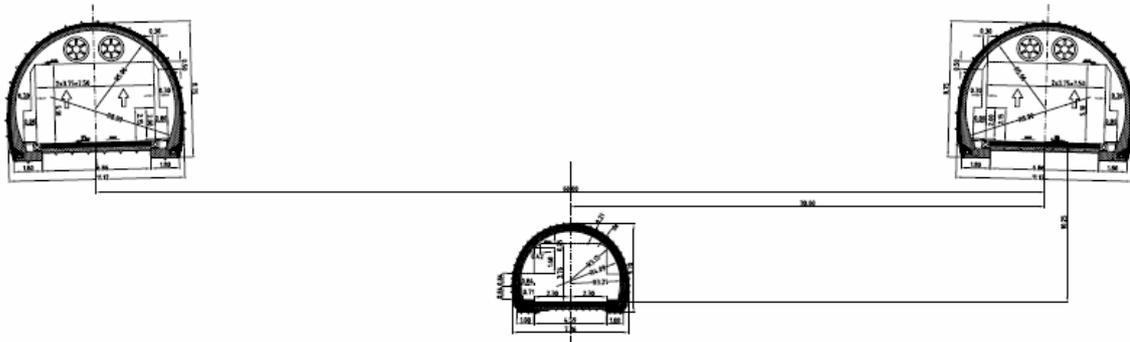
Corte transversal del Túnel en sector con excavación convencional
